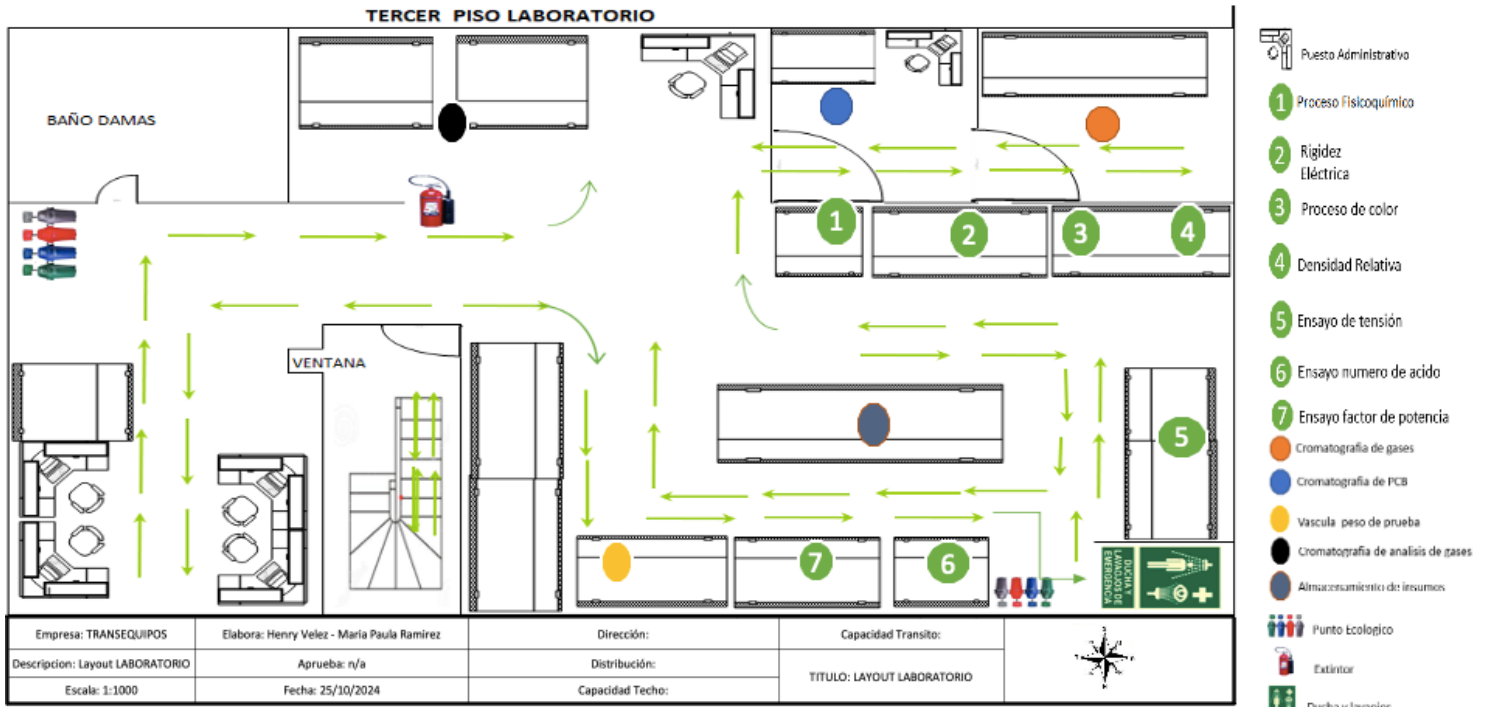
Diseño de Planta Transequipos después de la propuesta.
